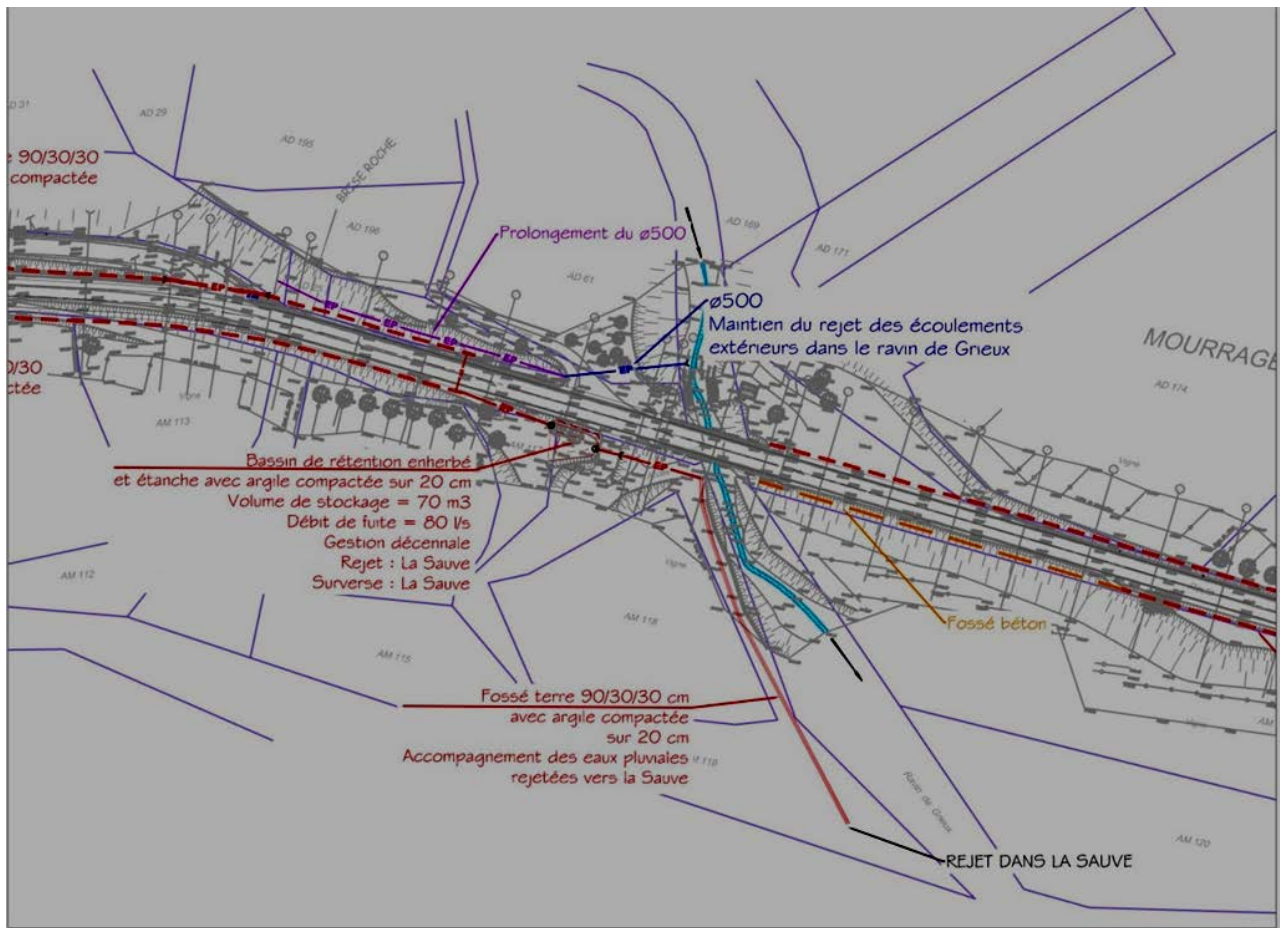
Le plan projet finalement retenu et conforme au dossier Loi sur l'eau
